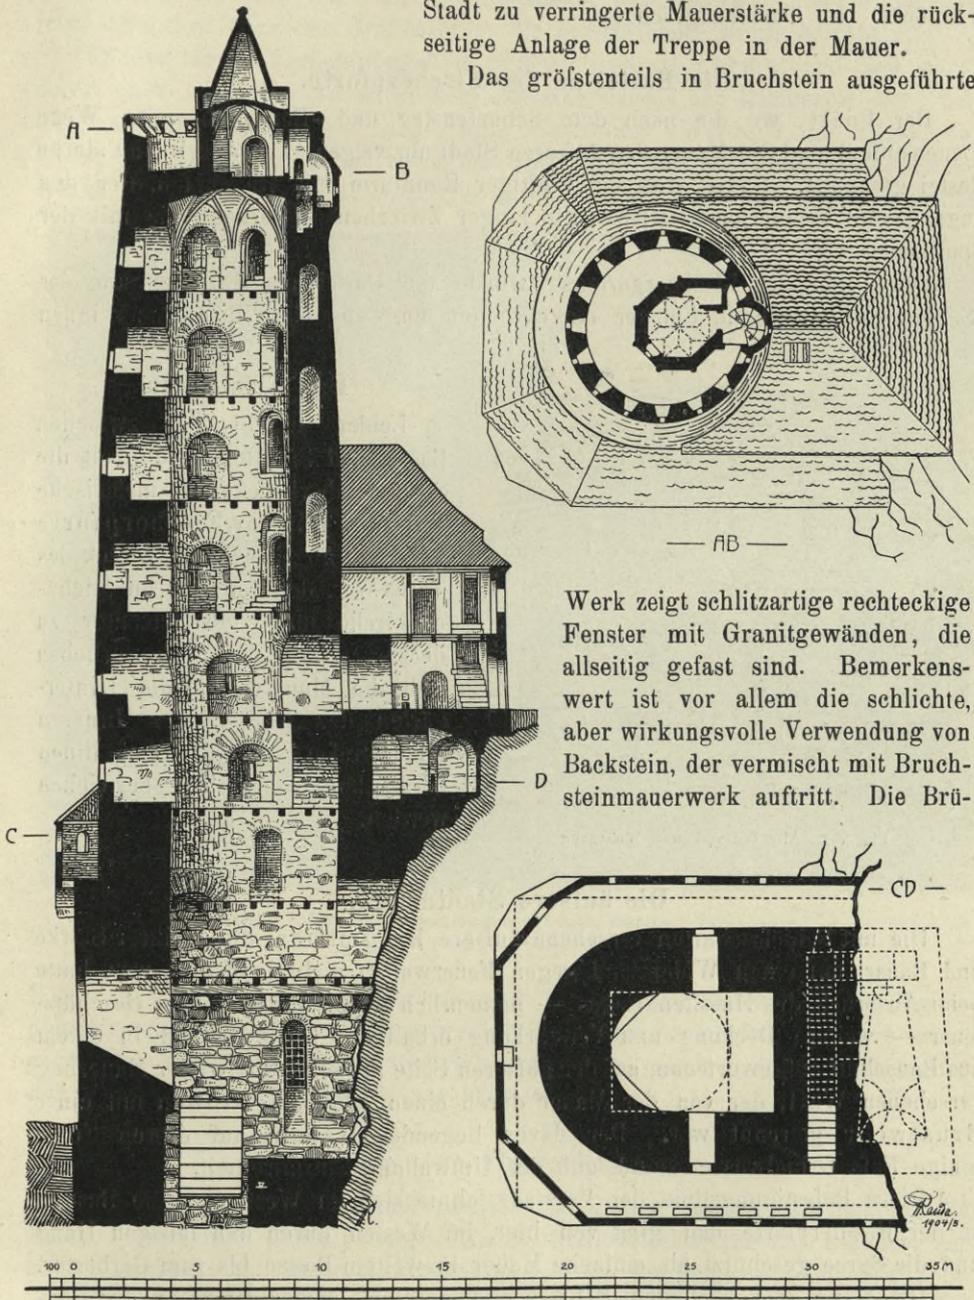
, 256 und 257. Alte Wasserkunst, Längenschnitt und Grundrisse nach CD und AB.
